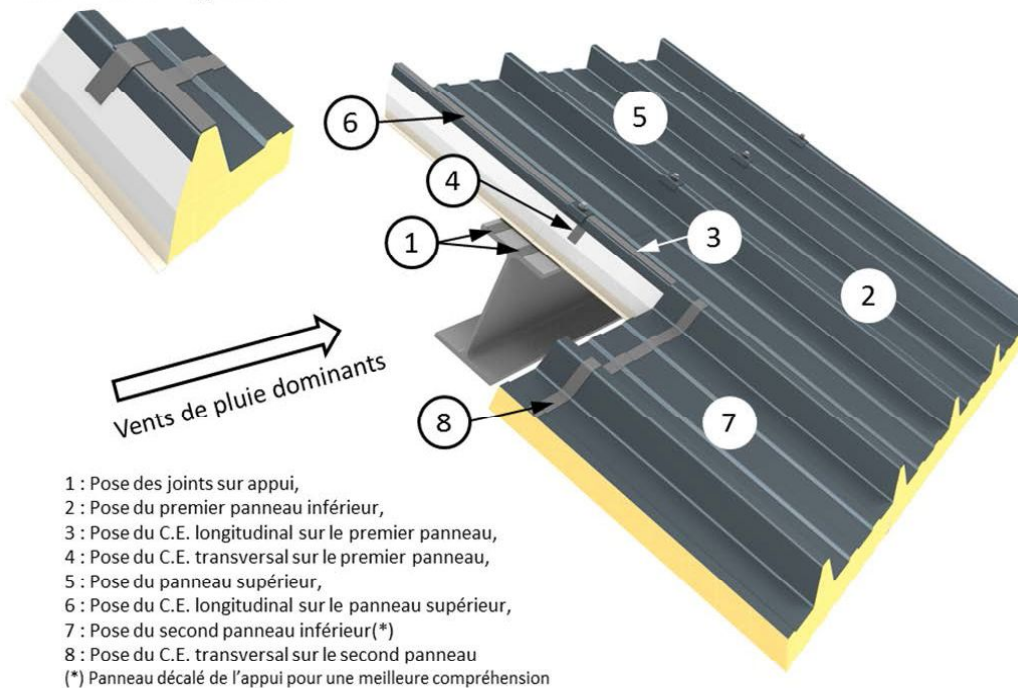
Détail sur appui – Joints sur appui au droit d'un recouvrement transversal de panneaux avec Complément d'Etanchéité (C.E.) transversal et longitudinal - locaux à faible ou moyenne hygrométrie (cf. §7.5)
